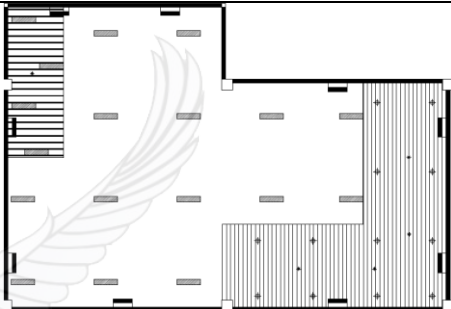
Alternatif Desain *Ceiling* Ruang Tutor
